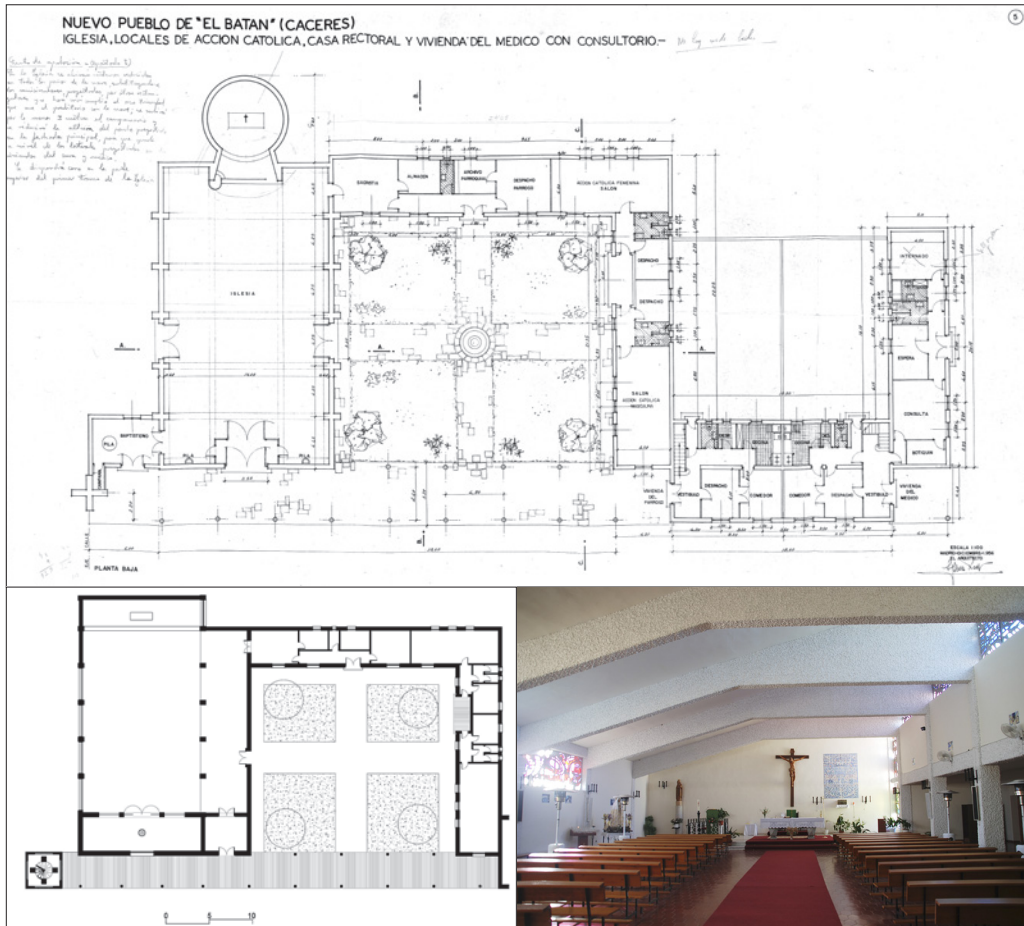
El Batán: planta del proyecto original, planta construida e interior. Salvador Álvarez Pardo, 1957.
